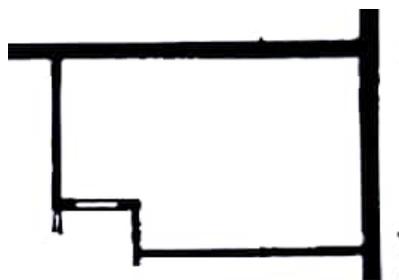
estratto planimetria catastale del solaio - sub. 13
